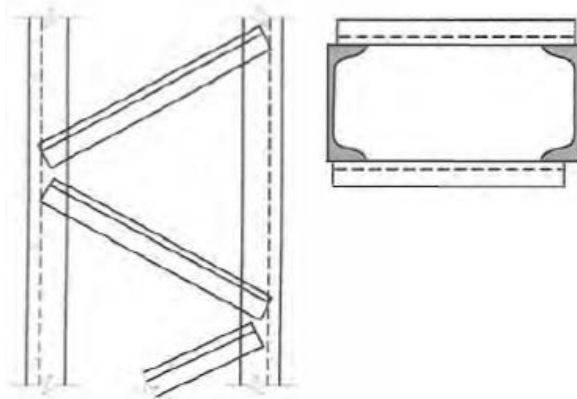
Composição adotada de perfis “U” com cantoneiras para pilares (Pfeil, 2011)
